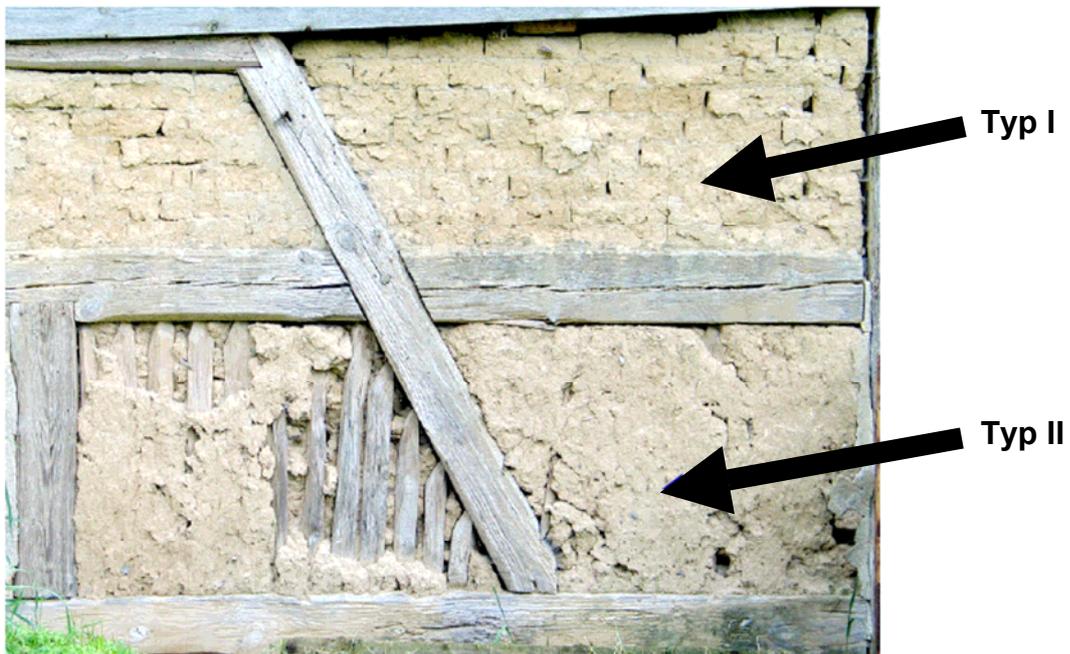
Darstellung eines historischen Fachwerks mit Ausfachungen des Typs I +II
